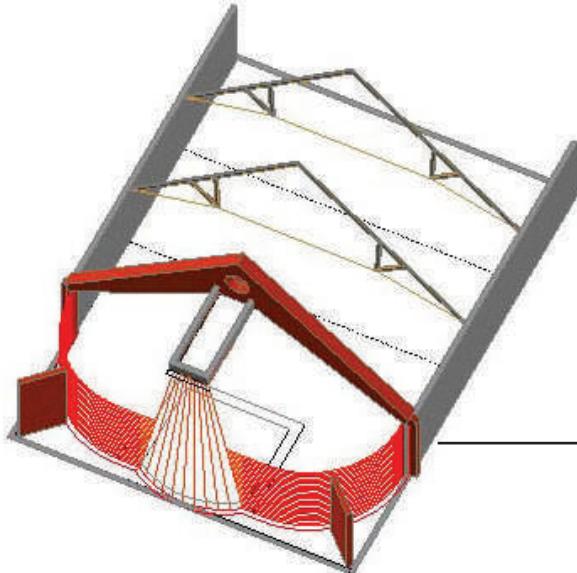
ETAPA 3 – Nesta etapa, estenderam-se as armaduras que saem das paredes curvas e chegam ao anel intermédio. Estas armaduras ultrapassam este anel e chegam ao anel superior. Após se faz a alvenaria inclinada, guiada pelas armaduras. Neste caso, ou noutro que se faça necessário se a parede - cobertura é muito inclinada e os tijolos escorregam, recorre-se ao detalhe (Fig. XII-82) para evitar este problema. (*-5).
